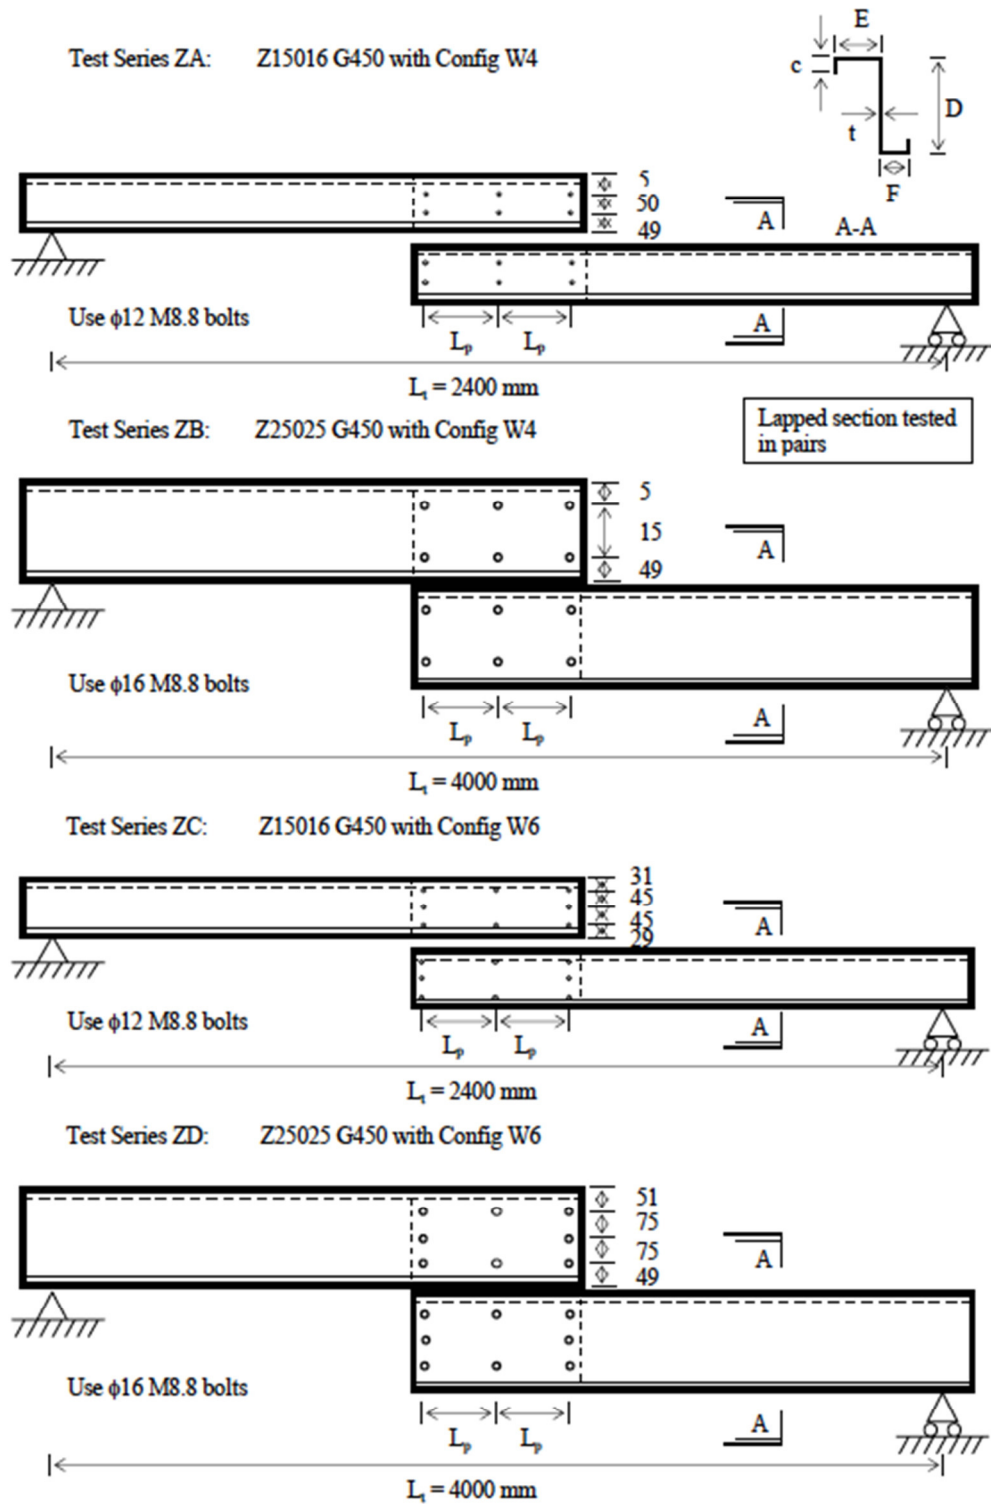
a Assetto generale delle prove sui profili con "overlap"
